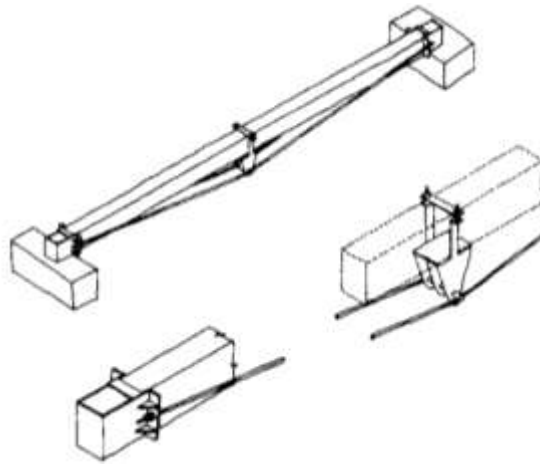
Refuerzo de viga mediante la disposición de un tirante inferior.
